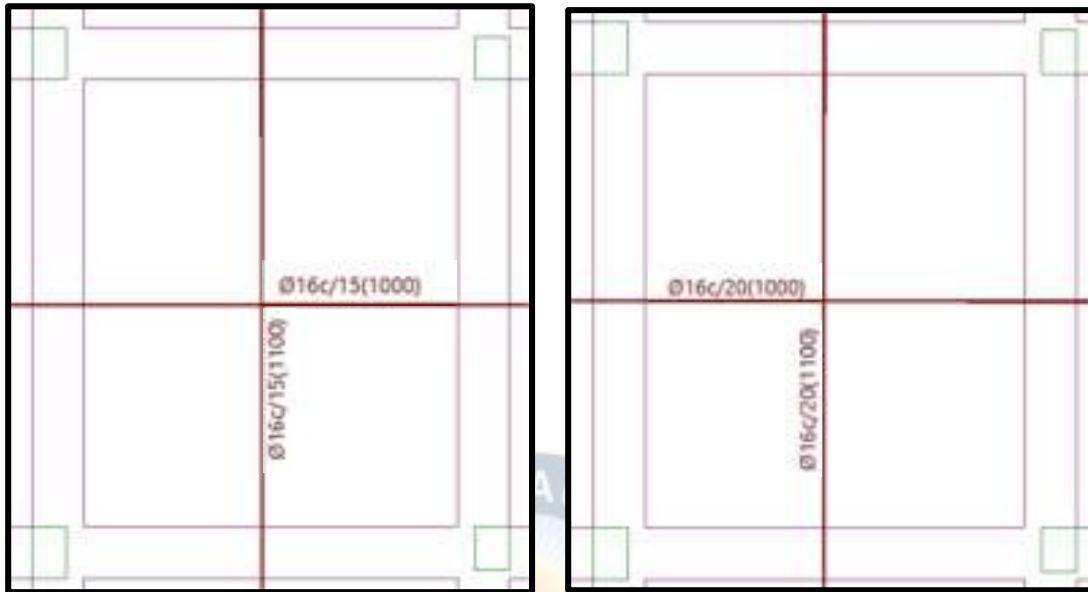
Esquema de armado longitudinal y transversal de la losa de Cimentación (Lado Izq.: Armado Inferior; Lado Der.: Armado Superior) s/ NB – 1225001
